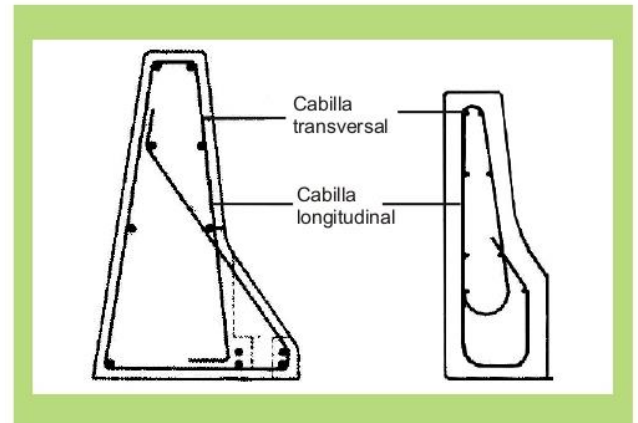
Detalles del acero de refuerzo en barreras de seguridad
